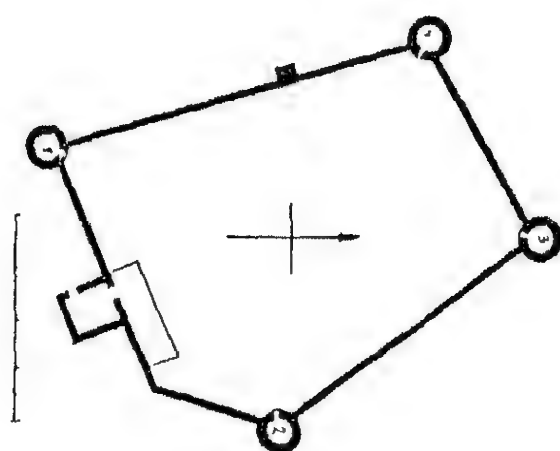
مسقط أفقي لأحد الأبراج في قلعة الأبراج السبعة بإستانبول (عن :
